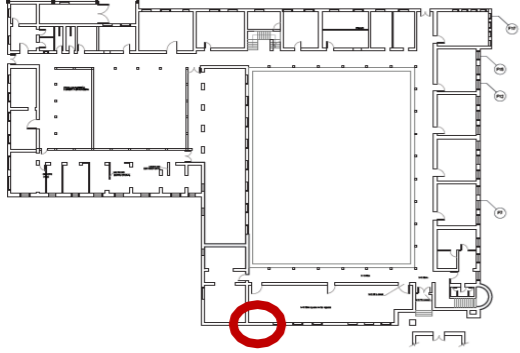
Levantamiento arquitectónico Planta Primer Piso.
